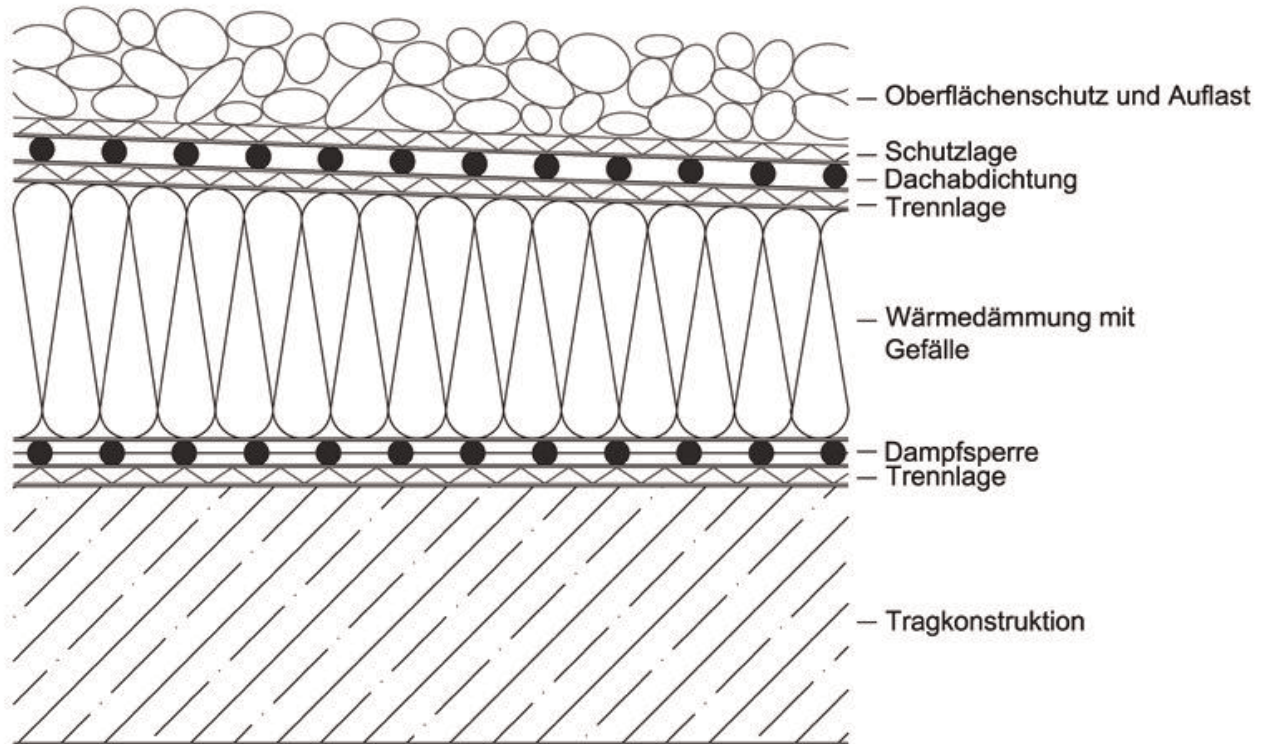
Konstruktionsart: Nicht belüftetes Dach, Wärmedämmung mit Gefälle, Abdichtung mit Kunststoff-/Elastomerbahnen, lose Verlegung mit Auflast
